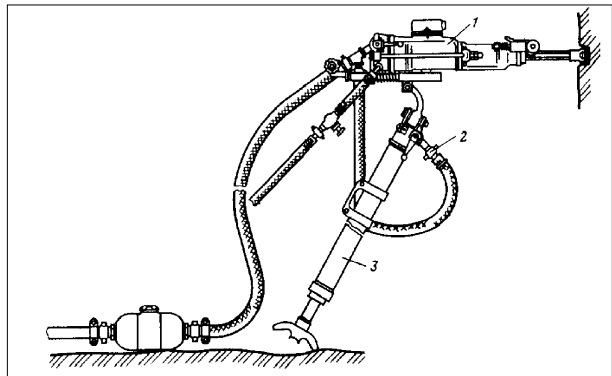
Схема установки пневматичної підтримки: 1 — перфоратор; 2 — регулювальний кран; 3 — пневматична підтримка.
